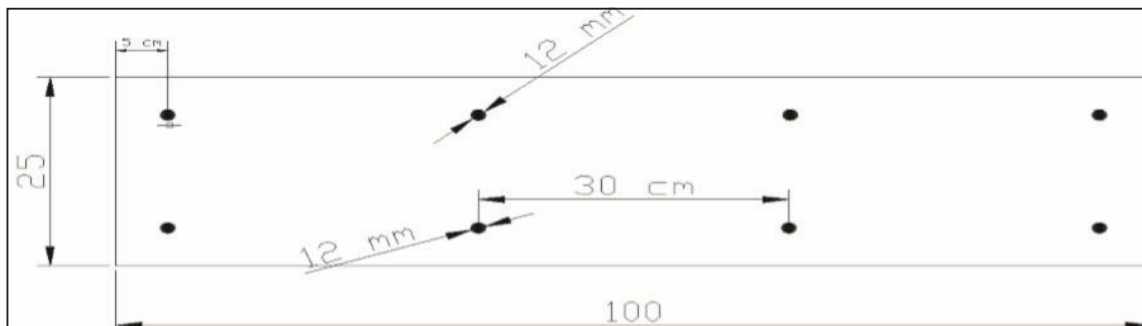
Schéma de ferrailage longitudinal de la dalle.
